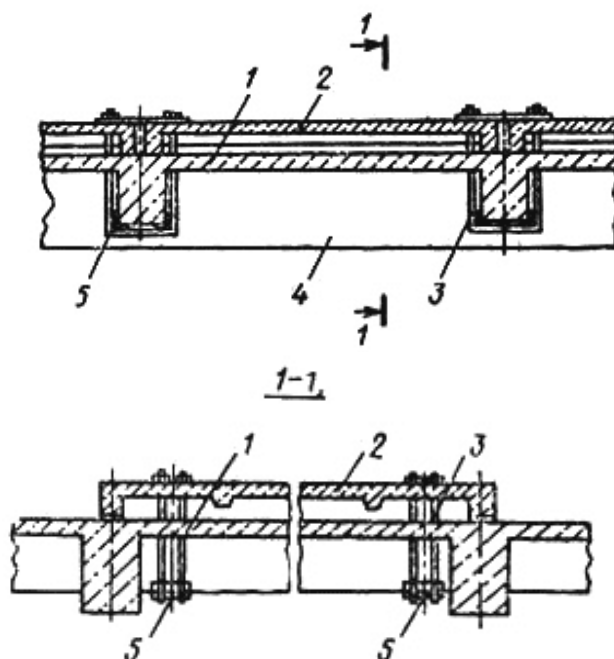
Разгрузка монолитной железобетонной плиты ребристой железобетонной плитой: 1 – разгружаемая плита; 2 – конструкция усиления; 3 – элементы крепления; 4 – ригель; 5 – прокладки
